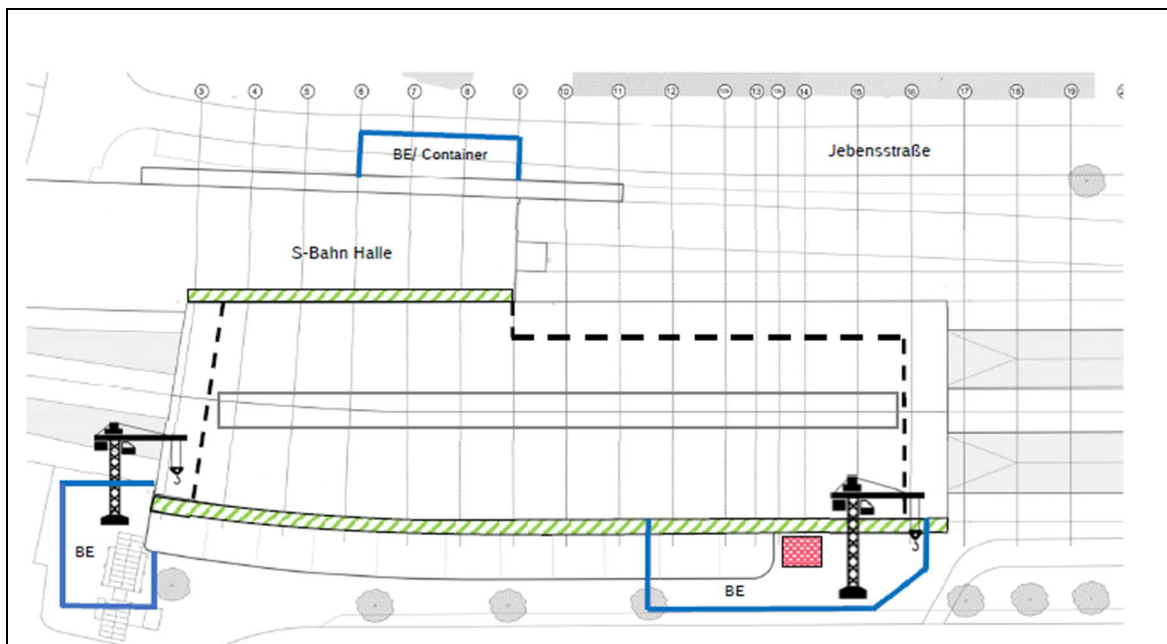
Übersichtslageplan Fernverkehrshalle [6]
